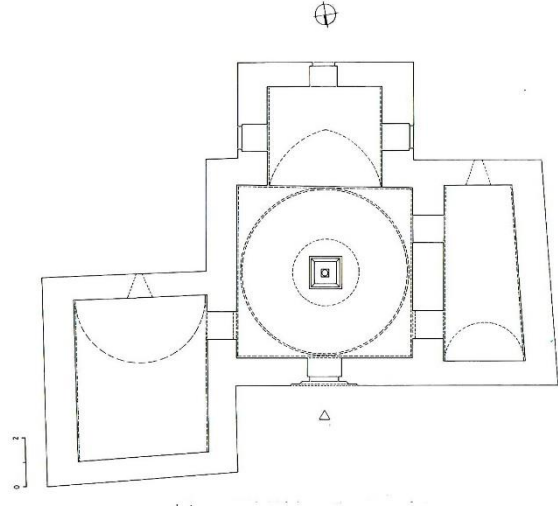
Erzurum Cimcime Hatun Türbesi planı
